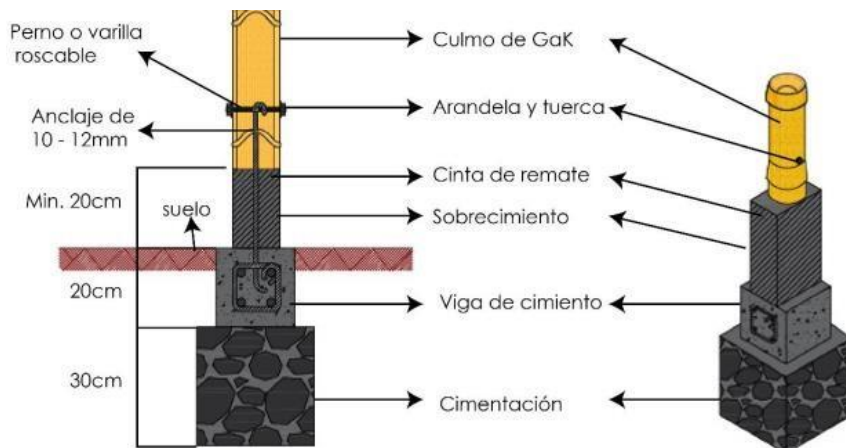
Anclaje de elementos GaK con la estructura de cemento y sobrecimiento
